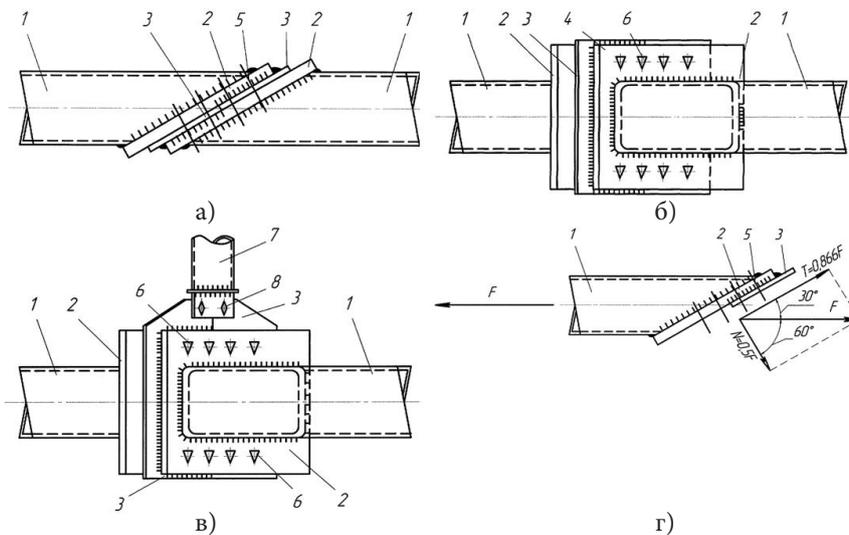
Предлагаемое фланцевое соединение растянутых элементов замкнутого профиля: а – вид сверху; б – вид сбоку; в – вид сбоку для случая прикрепления элемента решетки; г – расчетная схема; 1 – растянутые элементы замкнутого профиля; 2 – фланцы; 3 – опорные столики; 4 – выступающие части фланцев; 5 – соосные отверстия; 6 – стяжные болты; 7 – стержневой элемент решетки; 8 – дополнительные болты
